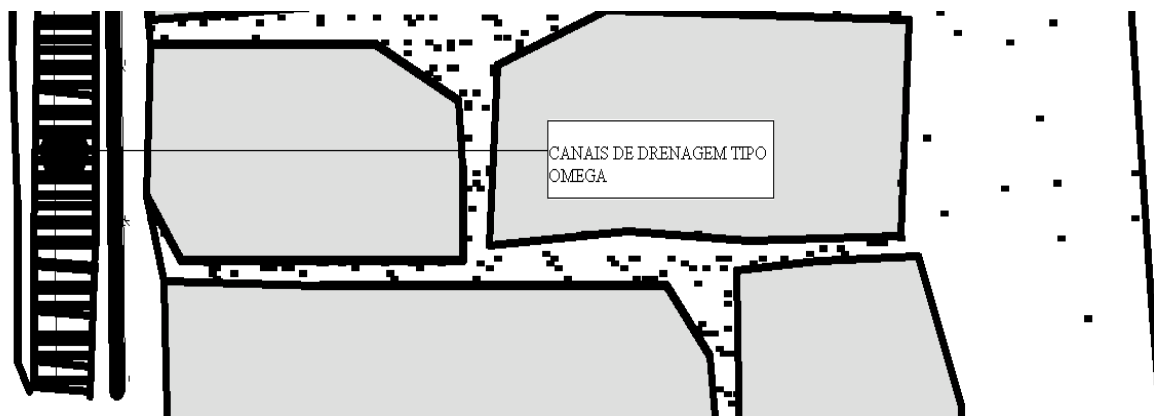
Pormenor2 de canais de drenagem (adapt. de GEG)
